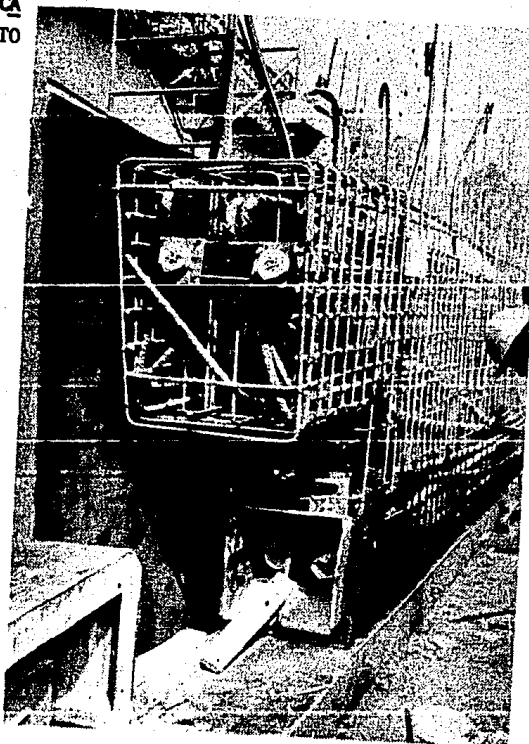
POSICION DE LOS CABLES EN LOS EXTREMOS DE LA TRABE Y REFUERZO POR CORTANTE.
